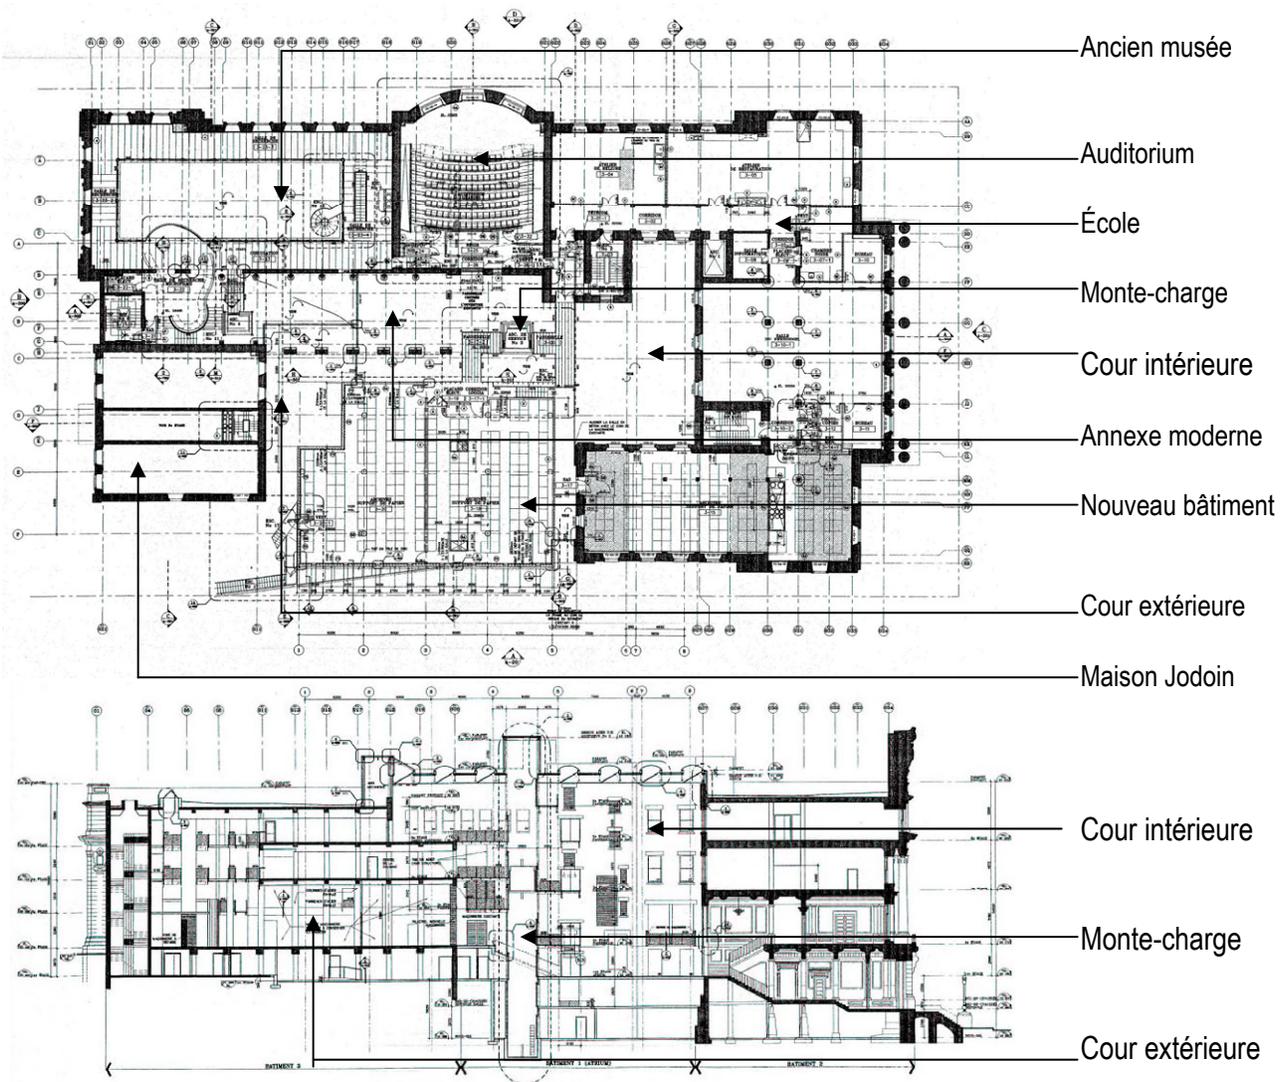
(A) Plan du Niveau 3 et (B) coupe longitudinale (Source: Dan S. Hanganu Architectes)
